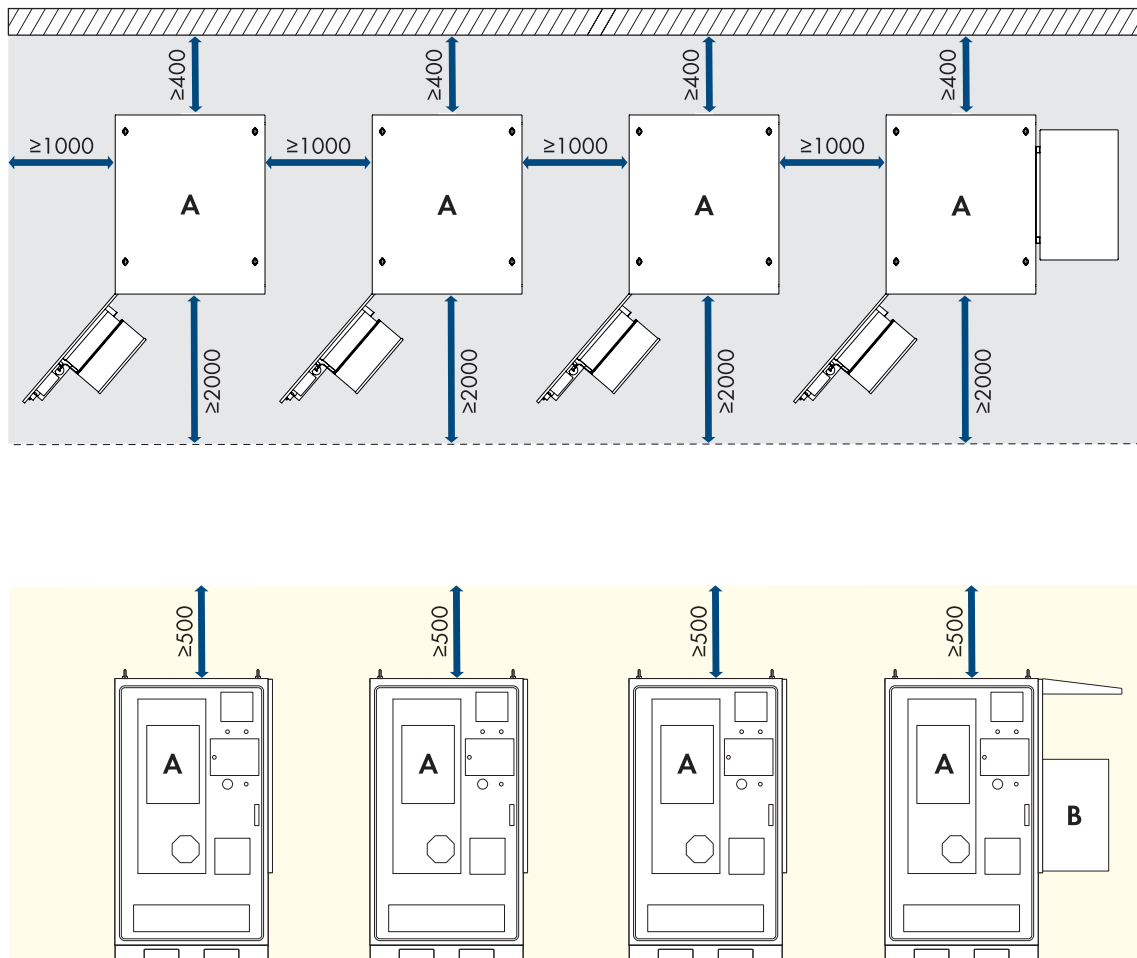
Exemple d'implantation d'un système avec 4 armoires de batteries (dimensions en mm)
